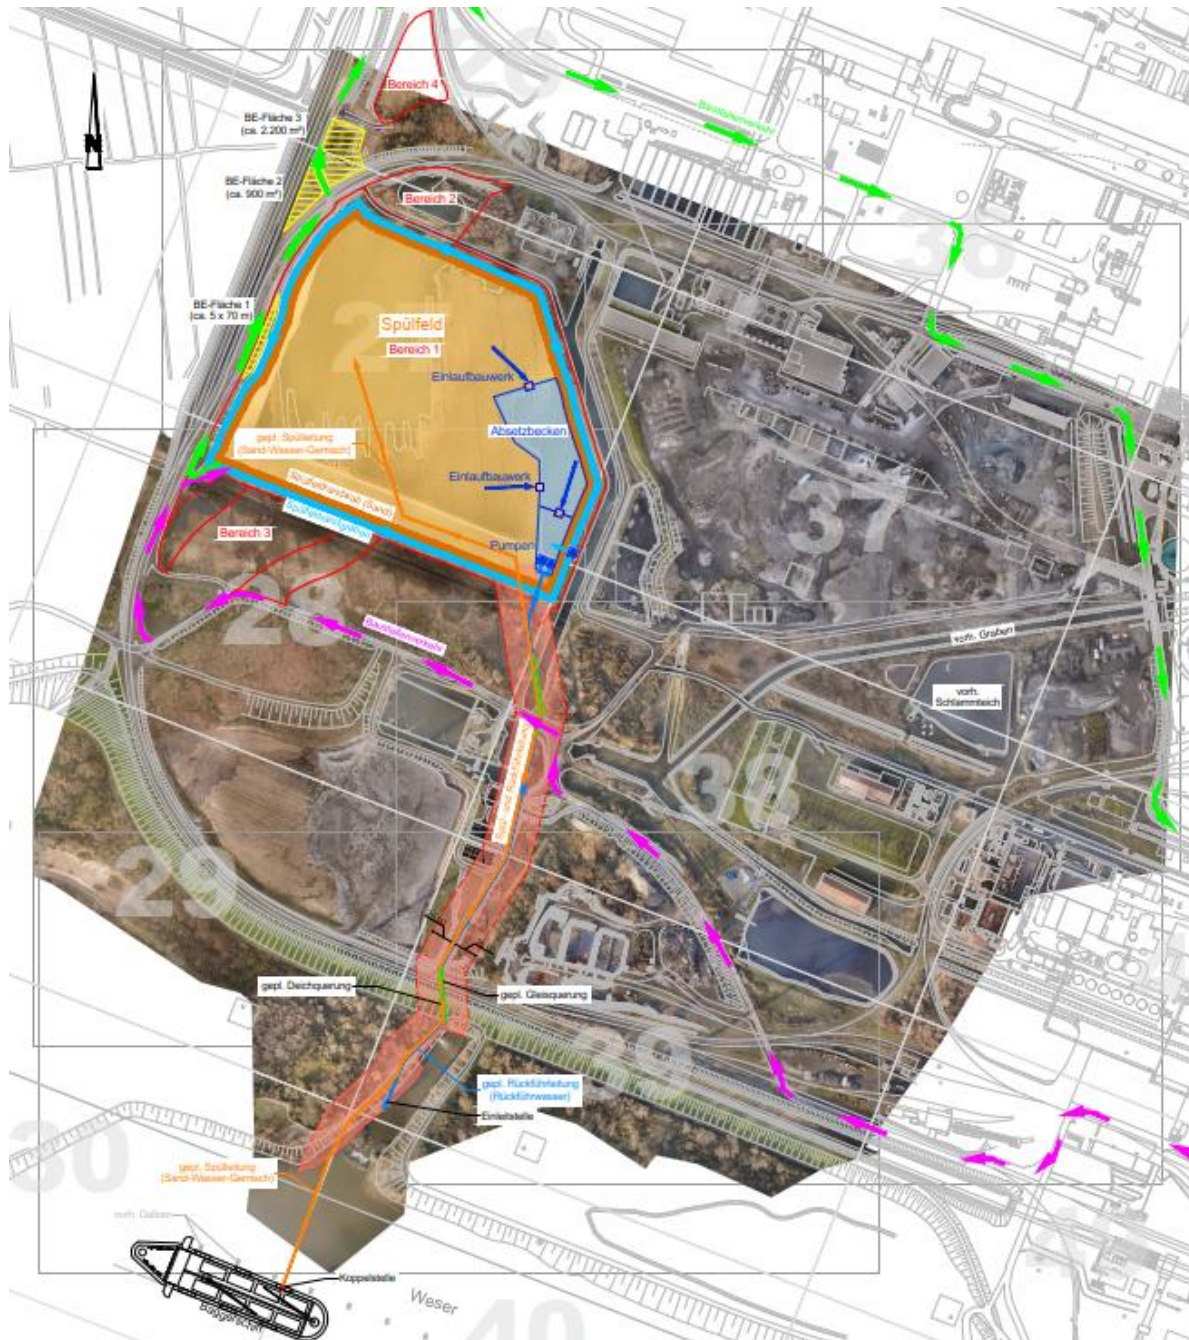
Lageplan Ausführungsweise 2
